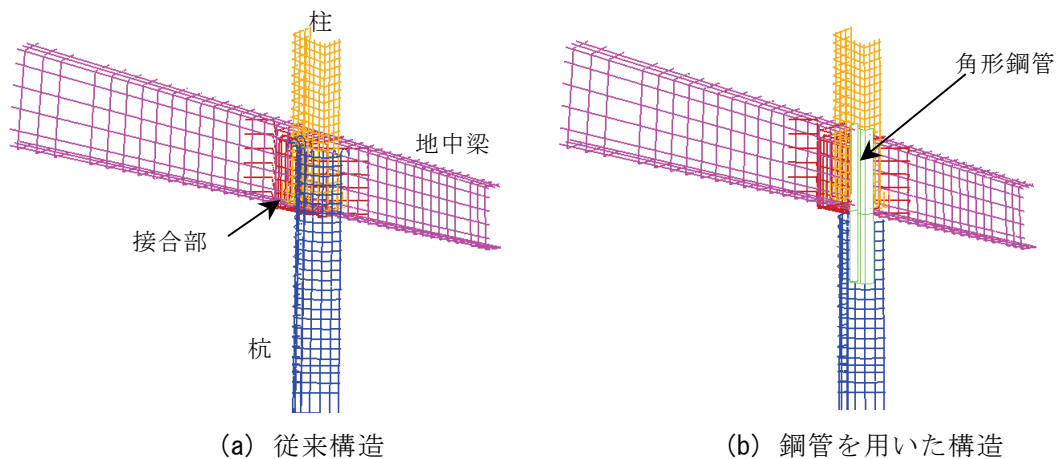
杭頭接合部の配筋状況の比較（半断面）
